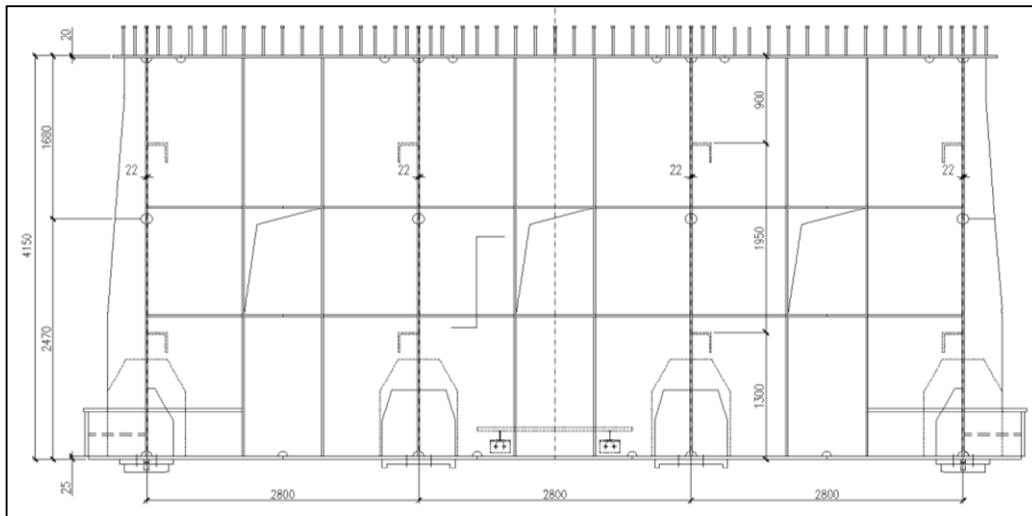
Progetto Esecutivo - Sezione in appoggio
